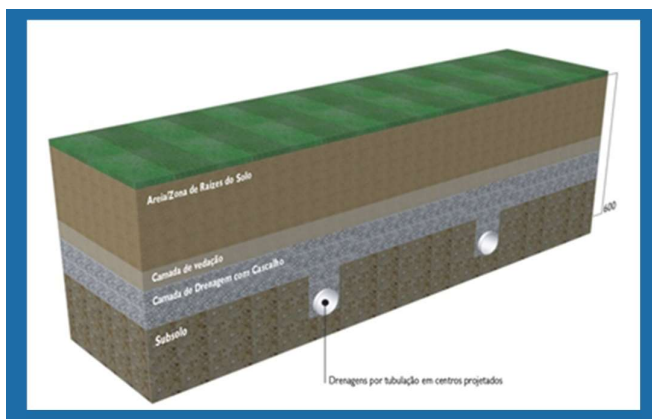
Perfil de una cancha con tubería de drenaje en suelo natural
